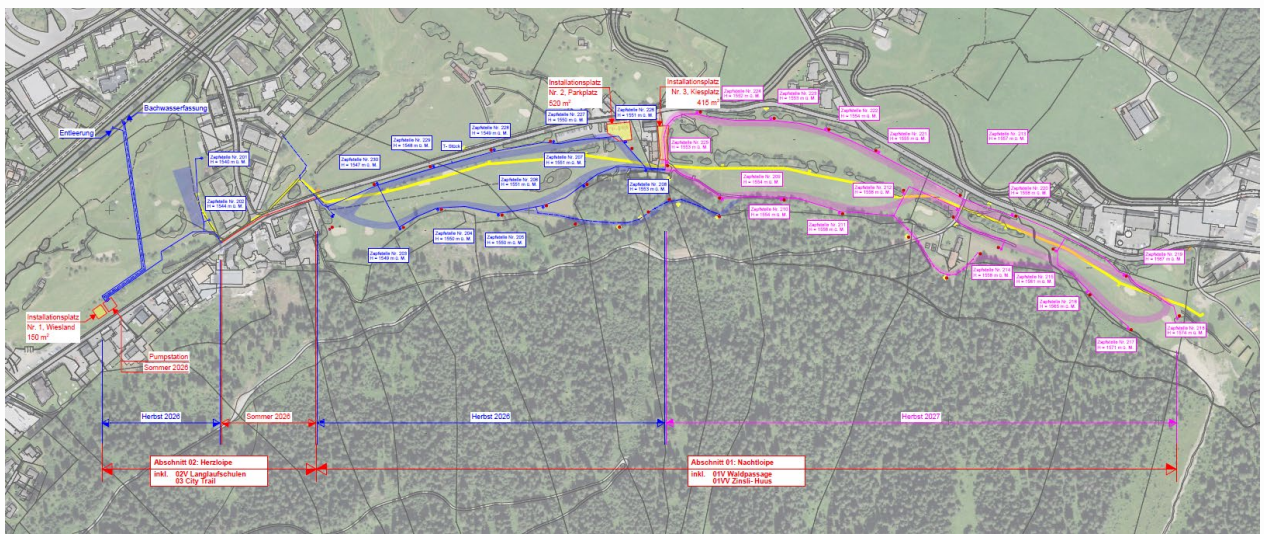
Ausschnitt aus dem Bau- und Installationsplan [7].
